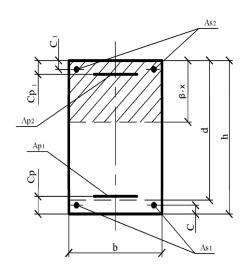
Поперечное прямоугольное сечение изгибаемого железобетонного элемента
